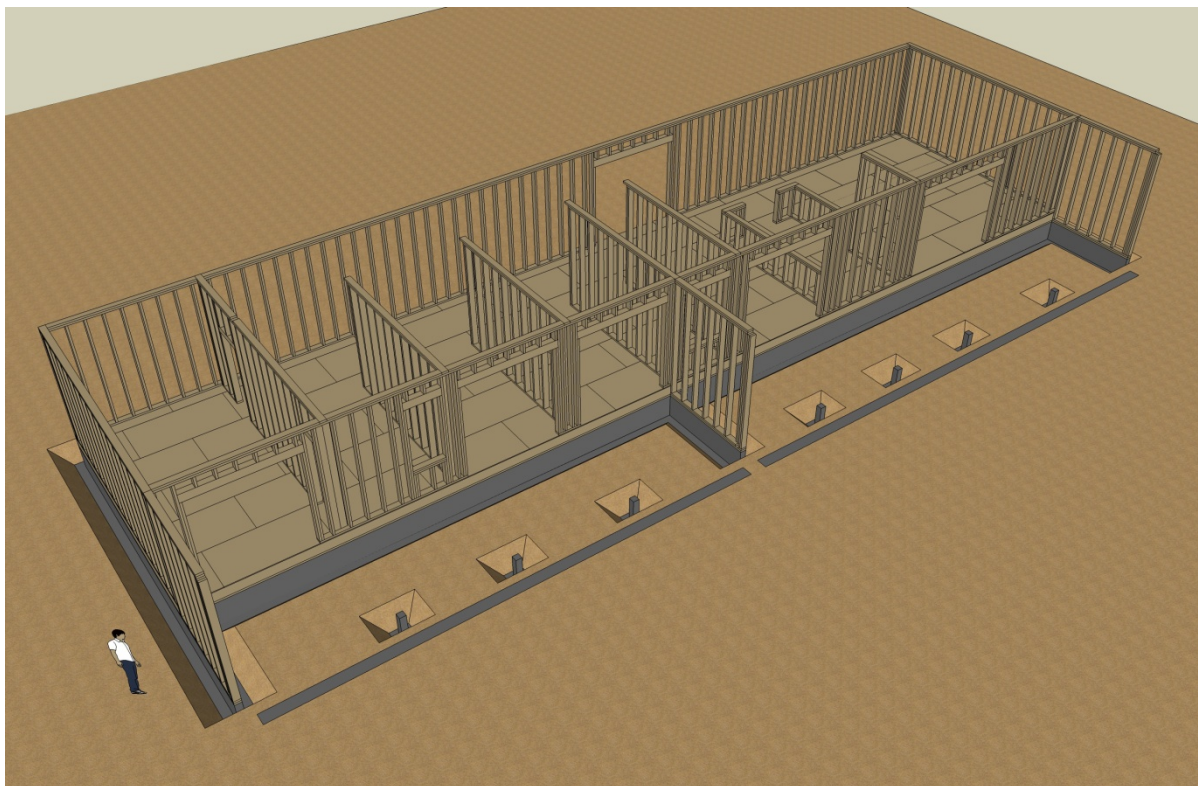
Montagem de paredes interiores transversais (pelo mesmo processo de construção sobre o pavimento) e remoção das escoras e tirantes das paredes exteriores.
